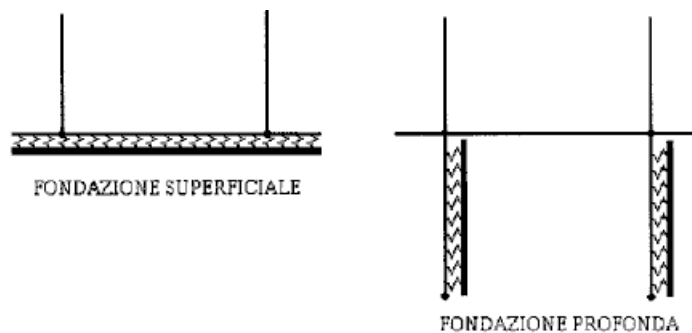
Modellazione delle fondazioni con elementi trave Winkler
